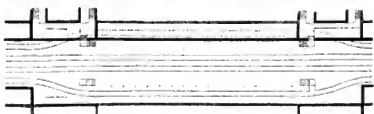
Grundriss einer Local-Station am Broadway (unterhalb 34. Strasse).
